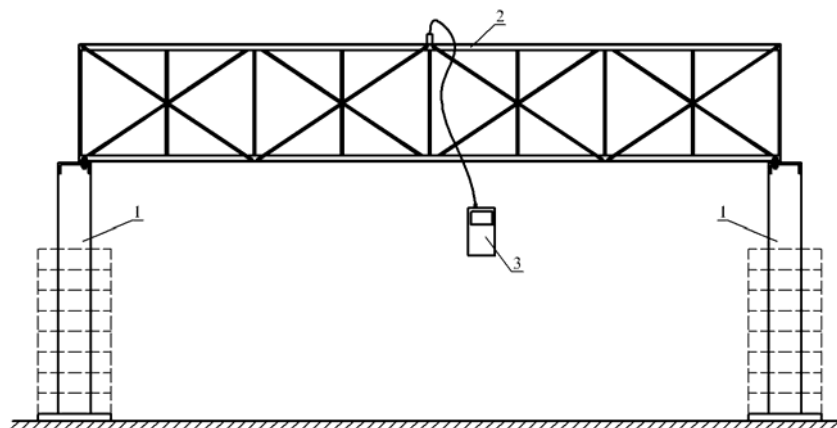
Принципиальная схема стенда для динамических испытаний ферм:
